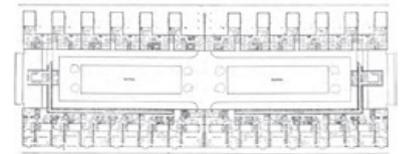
(2). Planta de conjunto. Immeuble-Villas.
